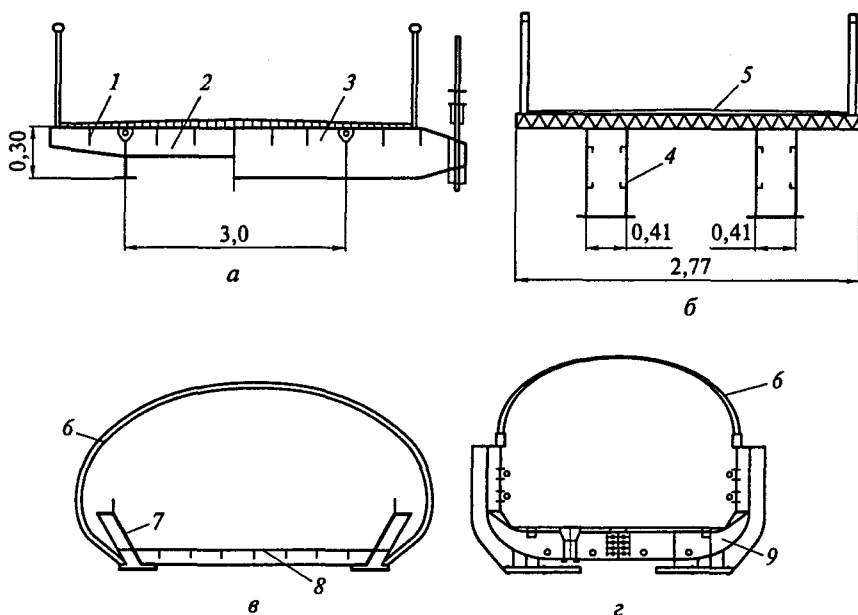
Поперечные сечения пролетных строений пешеходных мостов:
